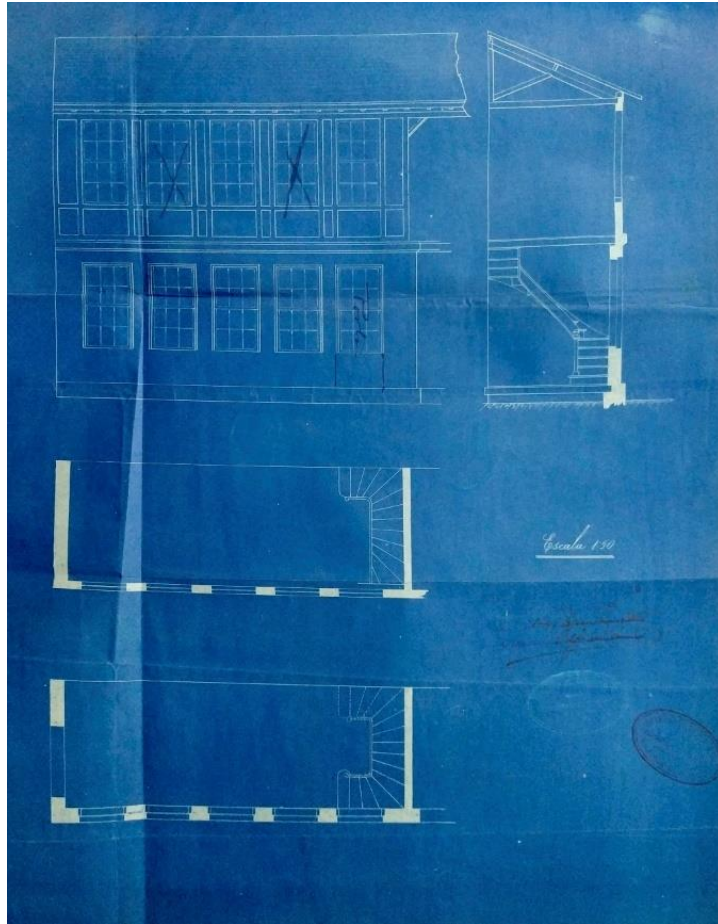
Planta anexada ao requerimento de construção de pavimento aos fundos do prédio da *Ernesto de Castro & Cia.*, 17. Fonte: Fundo Prefeitura Municipal de São Paulo, Direção de Obras e Viação, Obras Particulares, 1905, Volume 421.
